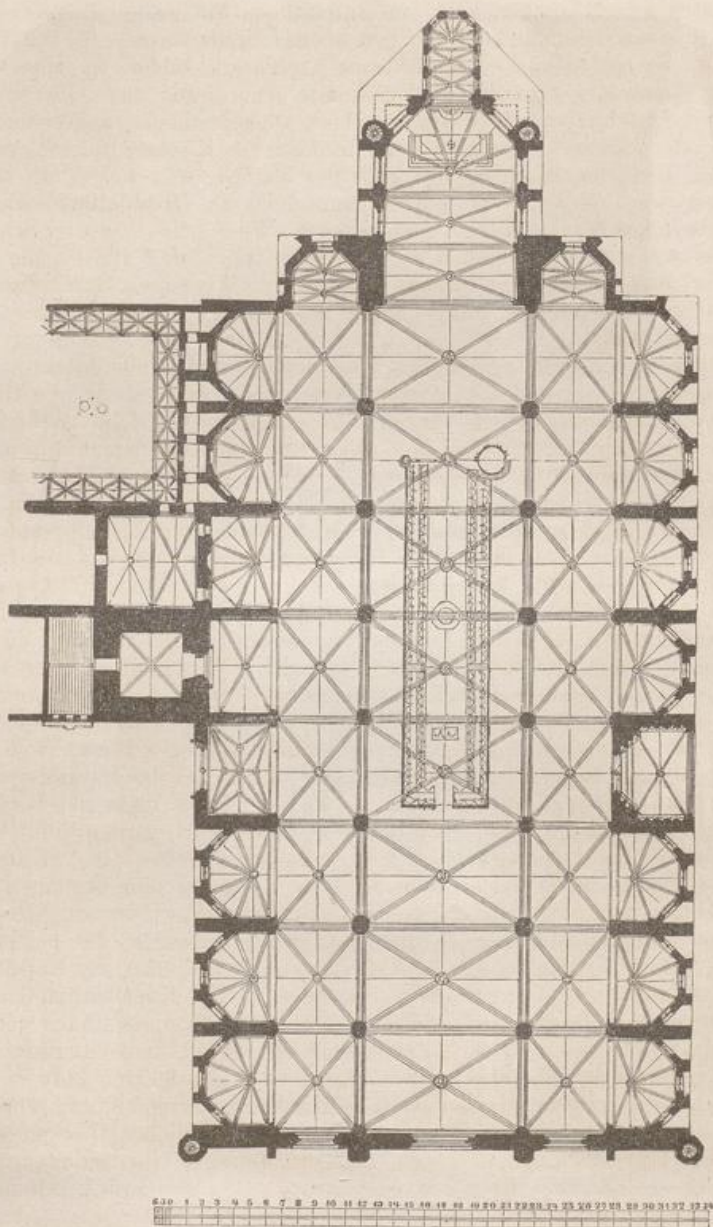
Grundriss von der Kathedrale zu Palma. (Schulcz-Ferencz.)
